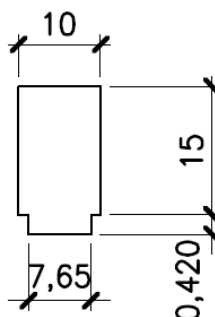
Seção transversal transformada para vigas reforçadas com 3CFJ (dimensões em cm).
